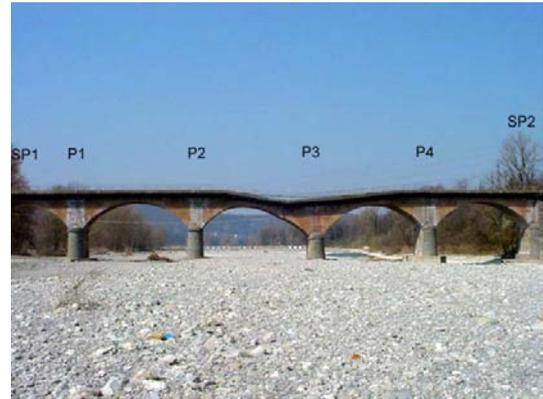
Vue longitudinale - piédroits en amont – du pont effondré
